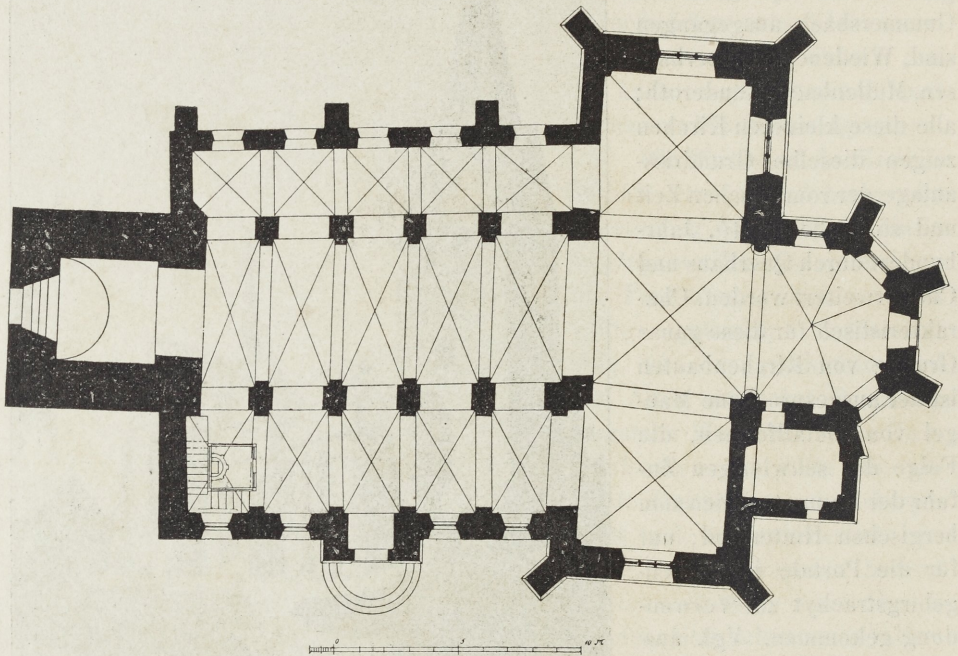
Gummersbach. Grundriss der evang. Pfarrkirche vor der Wiederherstellung.
